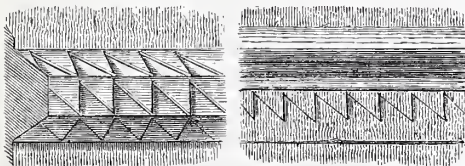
Sägezahnverzierung. Fig. 3057.
